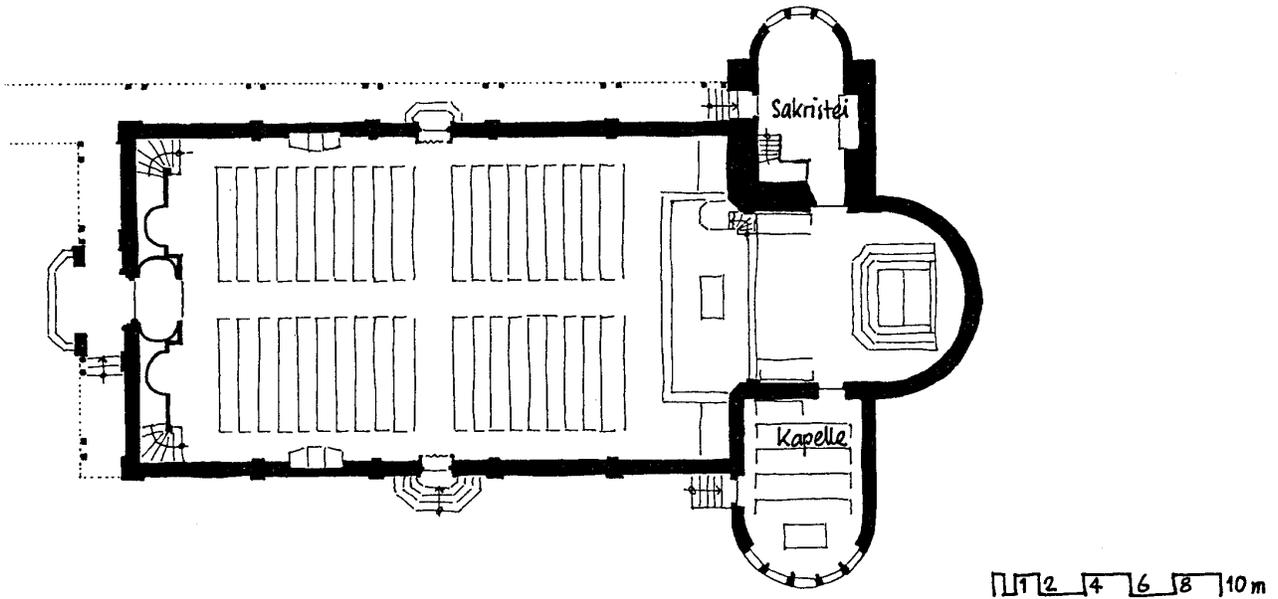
Grundriss katholische Kirche Steinebrunn
